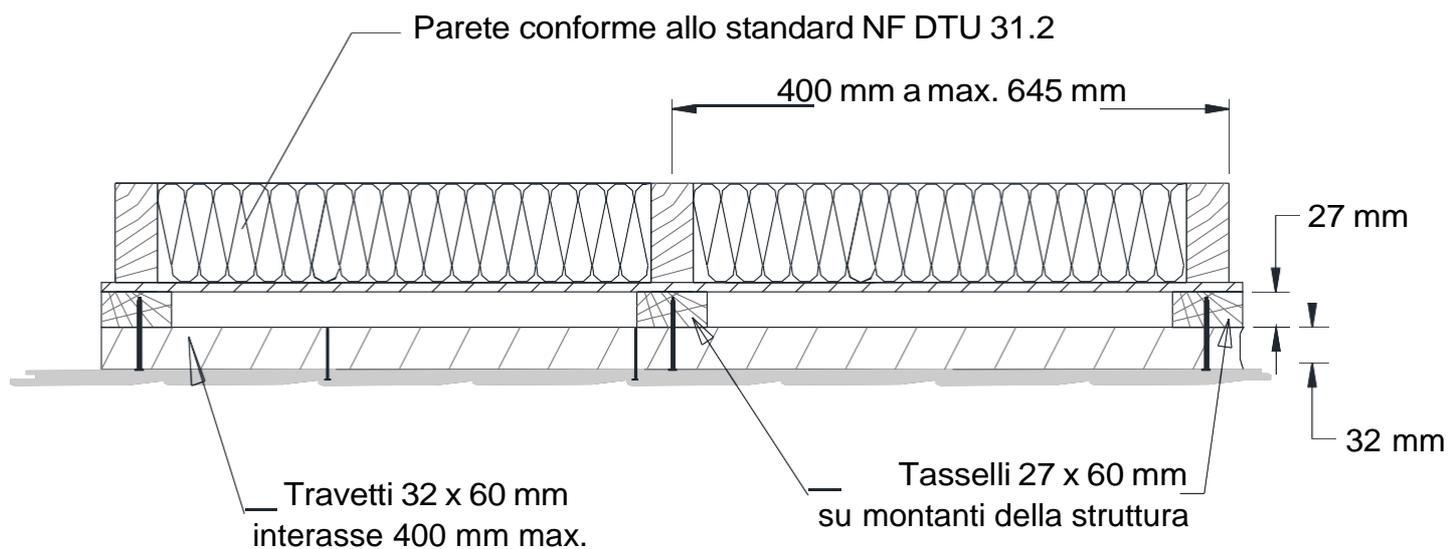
Sezione orizzontale su costruzione con struttura in legno – Posa verticale – Posa su doppia travatura
